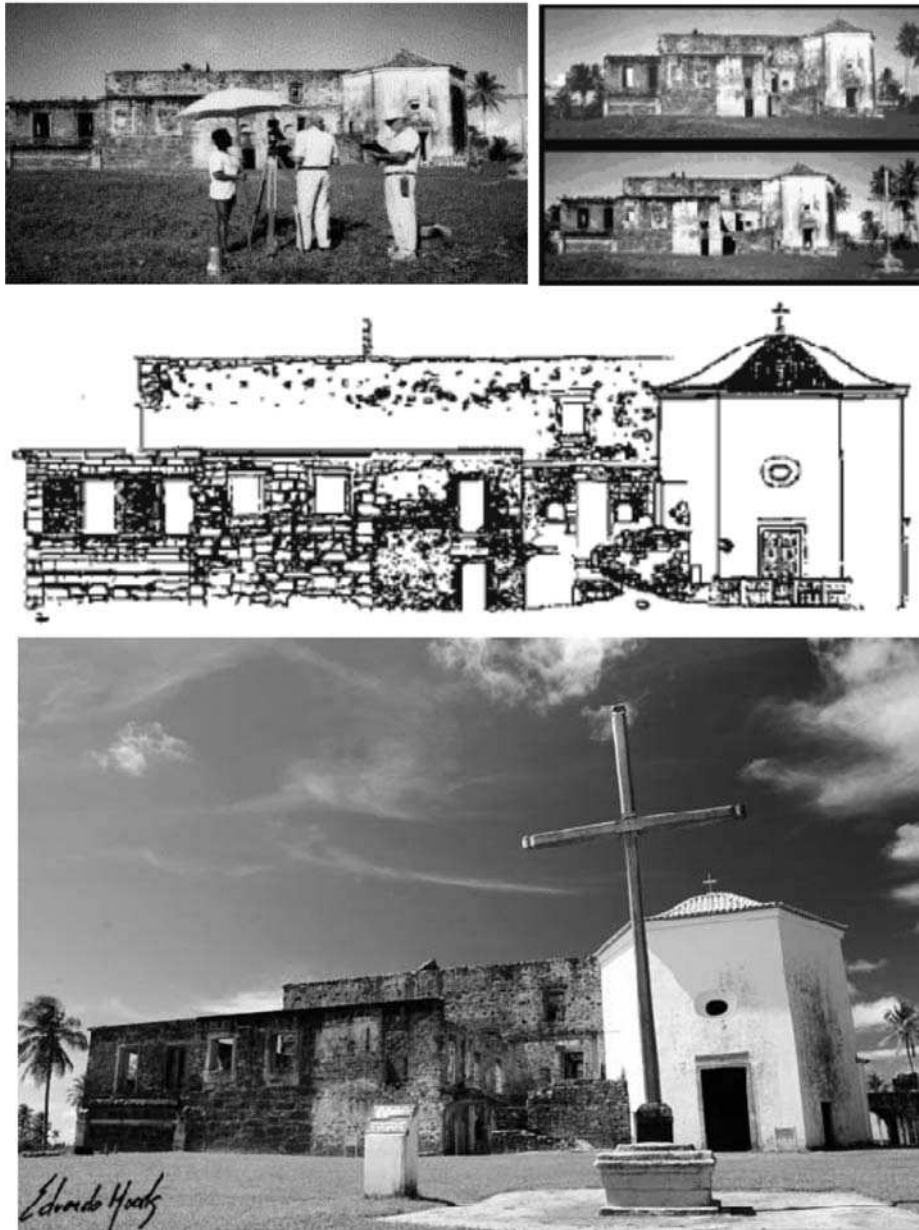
Castelo Garcia d'Ávila – vista do levantamento fotogramétrico terrestre, par estereoscópico, planta da fachada e fotografia artística da construção com a capela semi-restaurada (fonte: Fundação Garcia d'Ávila).
